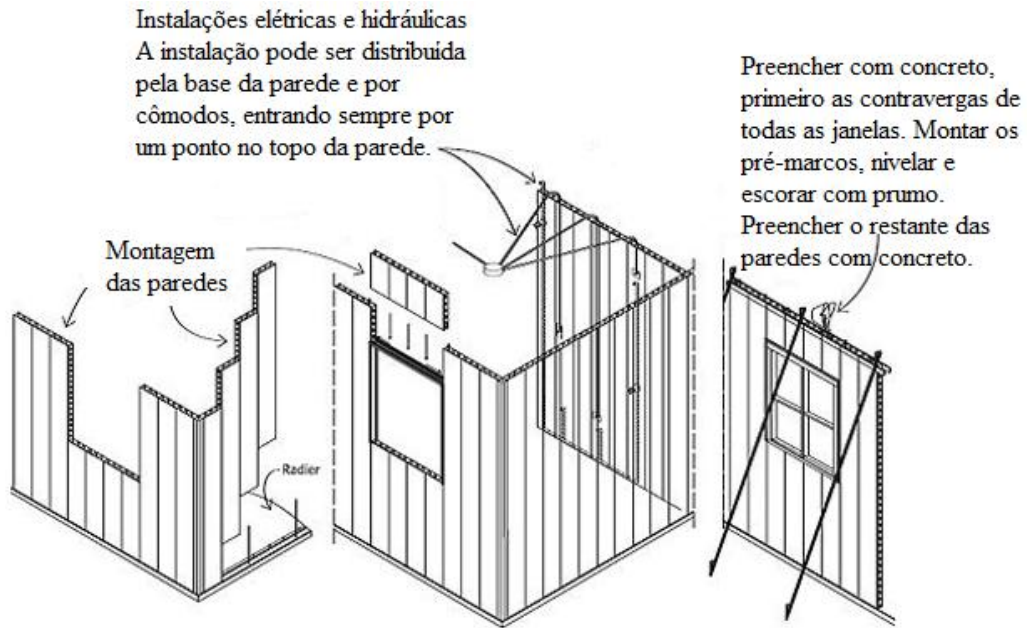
Esquema de montagem do Sistema Concreto PVC.
